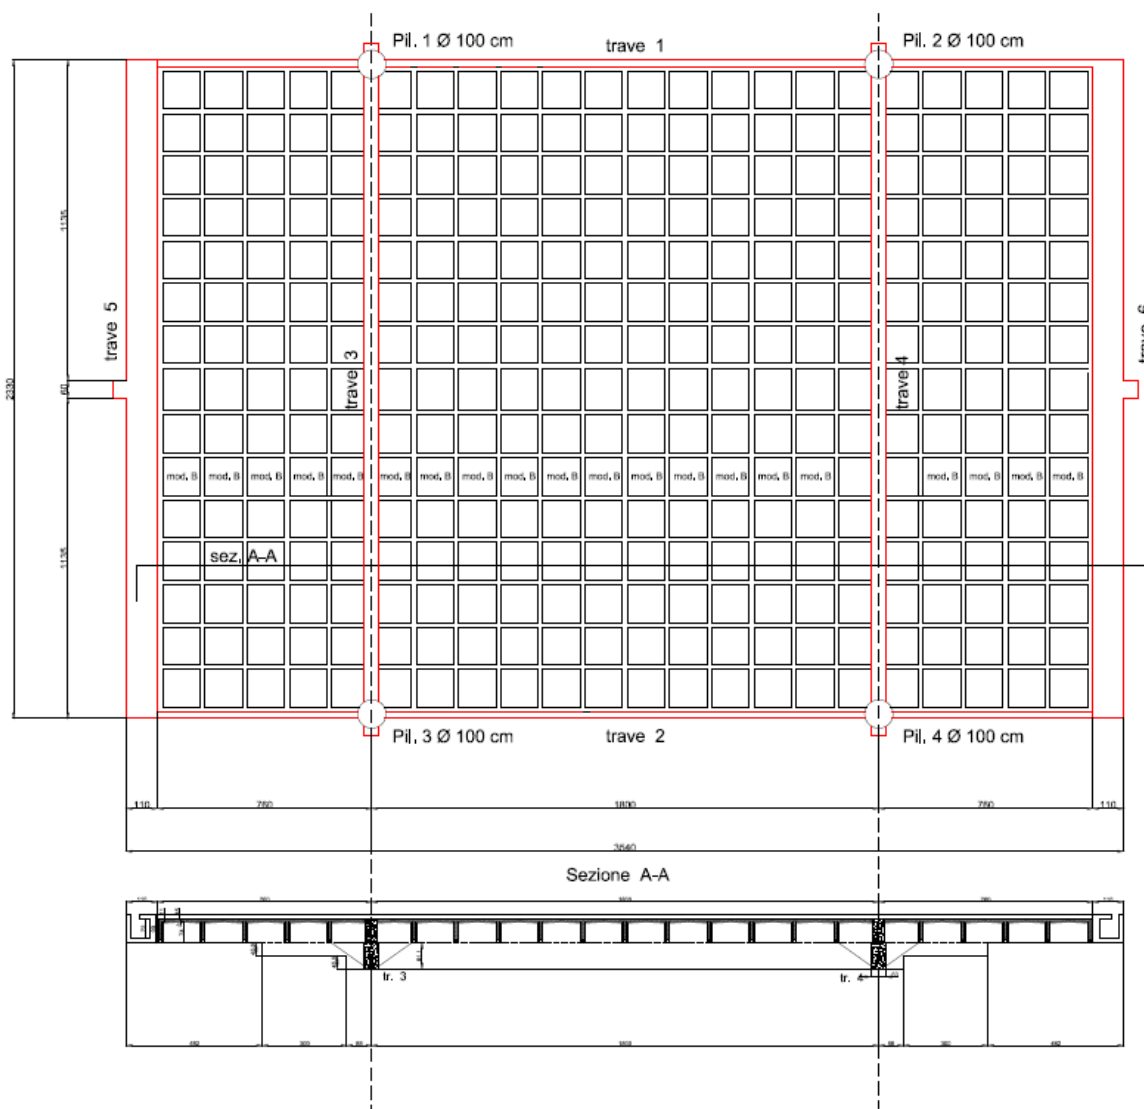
Schema planimetrico e sezione longitudinale della struttura in c.a. di copertura della vasca natatoria con localizzazione dei pilastri a sezione circolare
